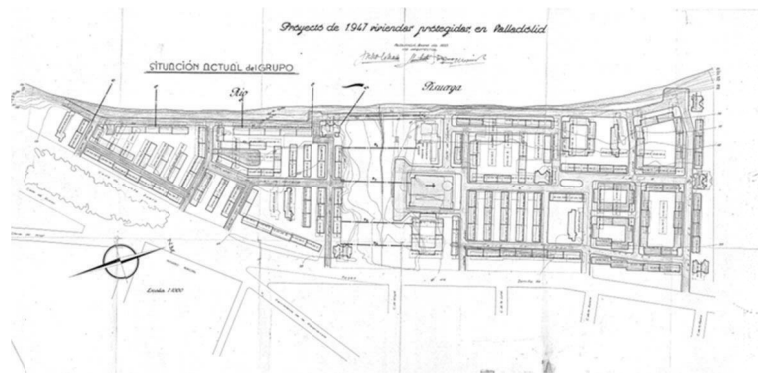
Plano del conjunto del "Cuatro de Marzo".
